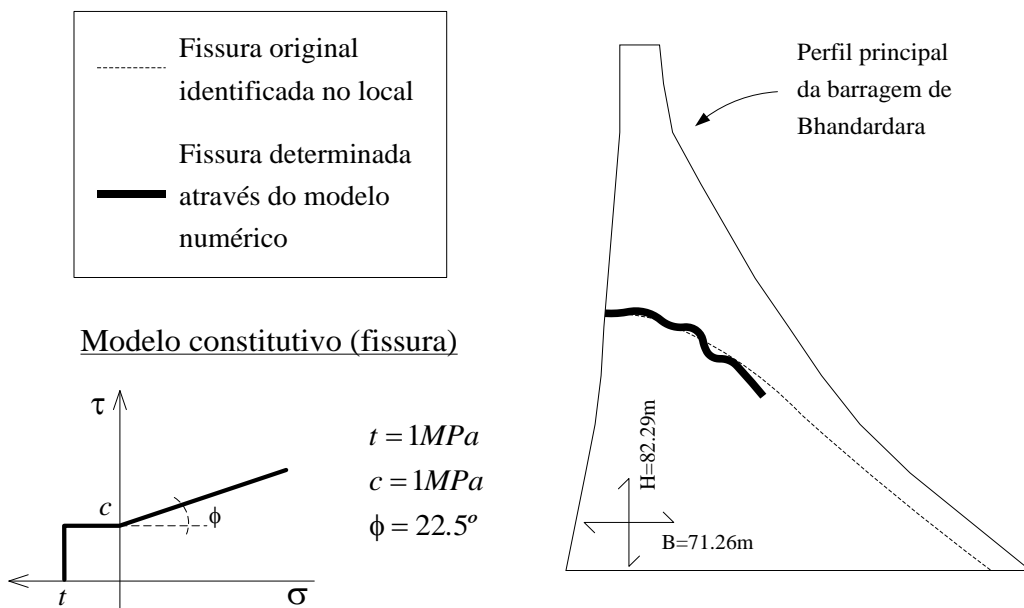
Modelo A₃ – Análise estática – Propagação da fissura
